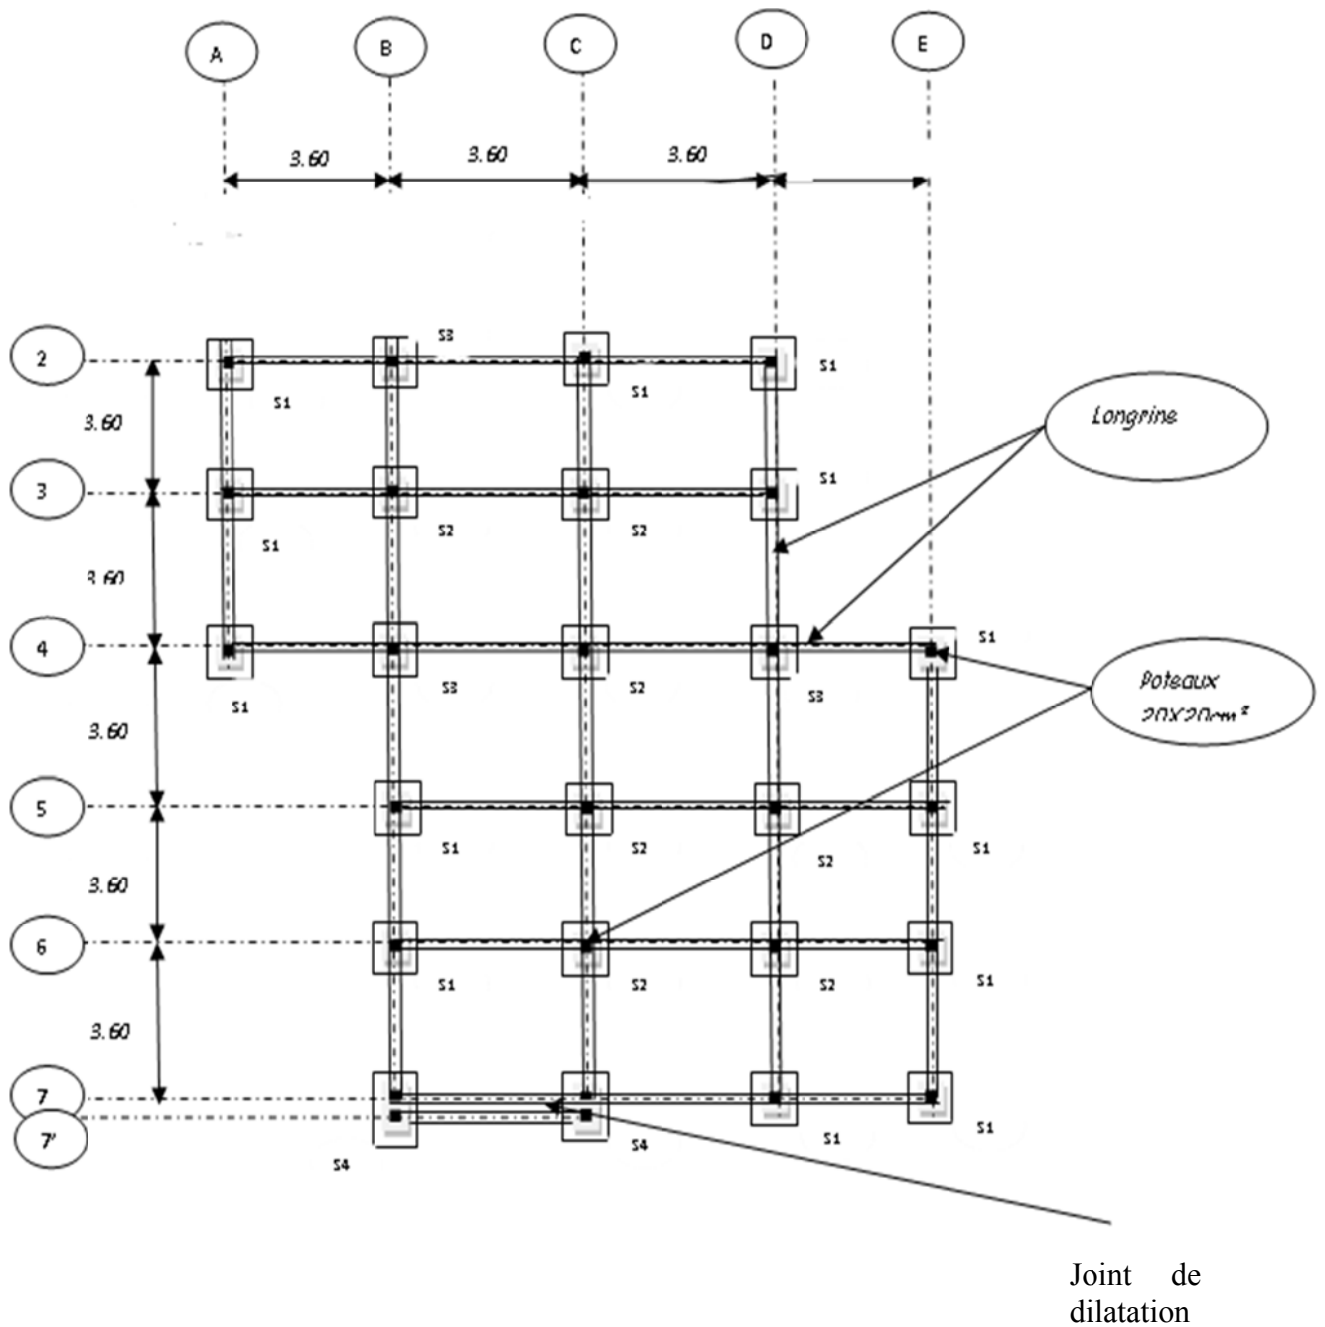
Coffrage des semelles, des longrines et des avants poteaux d'un bloc du bâtiment hébergement.
